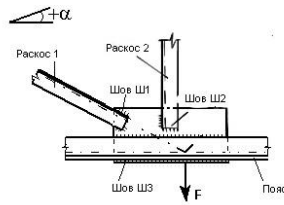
Конструкторский чертеж узла номер 2
